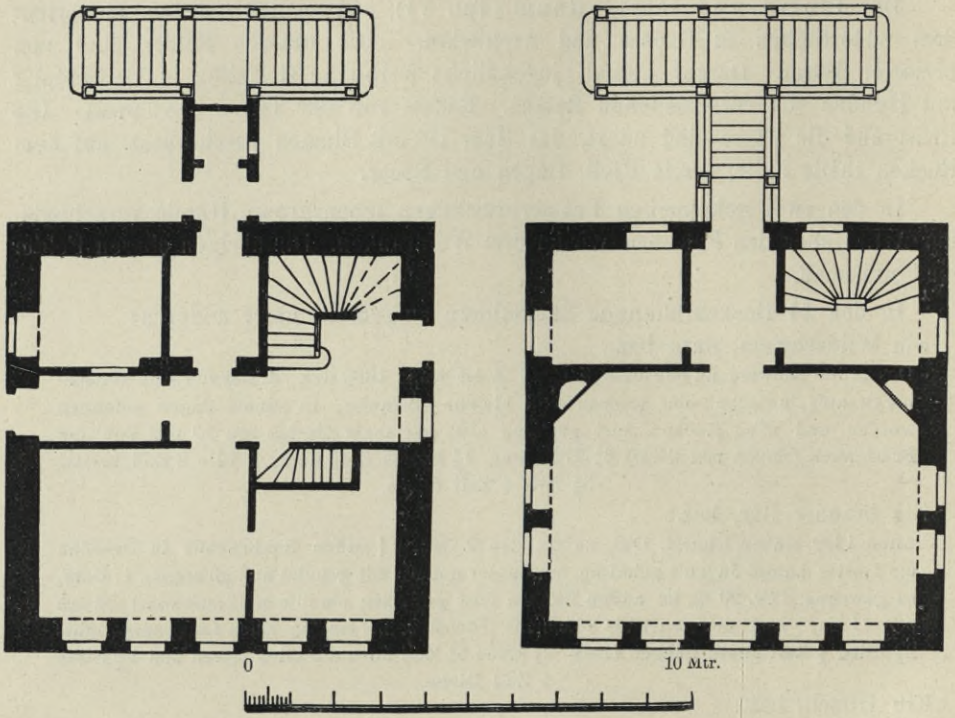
, 154. Spitzhaus, Grundriss der beiden Obergeschosse.
